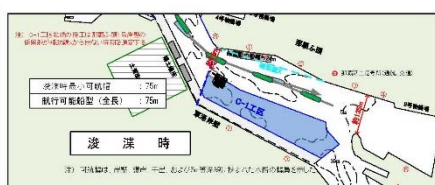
C-1 工区の施工範囲（潜水探査作業および浚渫共通）
